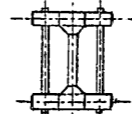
Alzado de costado de una pila metálica. (Escala 1/400)
